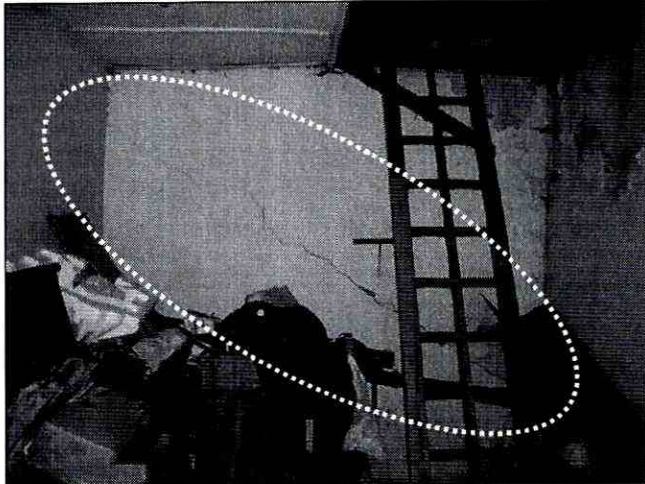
Se observa una de las grietas identificadas en uno de los muros divisorios de las edificaciones en mampostería simple evaluadas.
